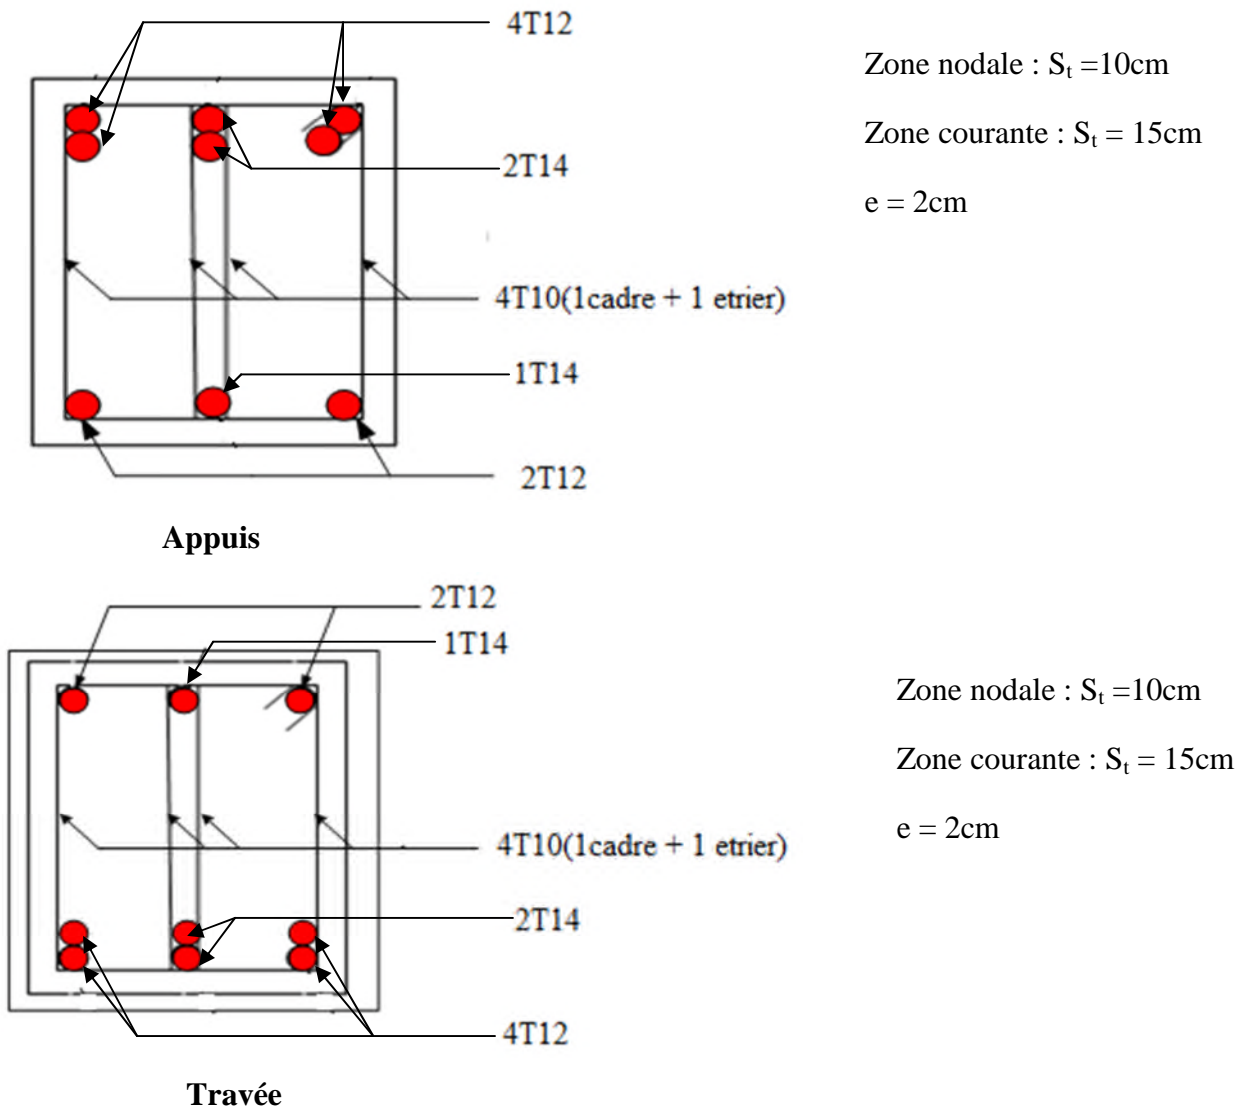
Schéma de ferrailage des poutres secondaires du 5^{ème} et 6^{ème} étage.
